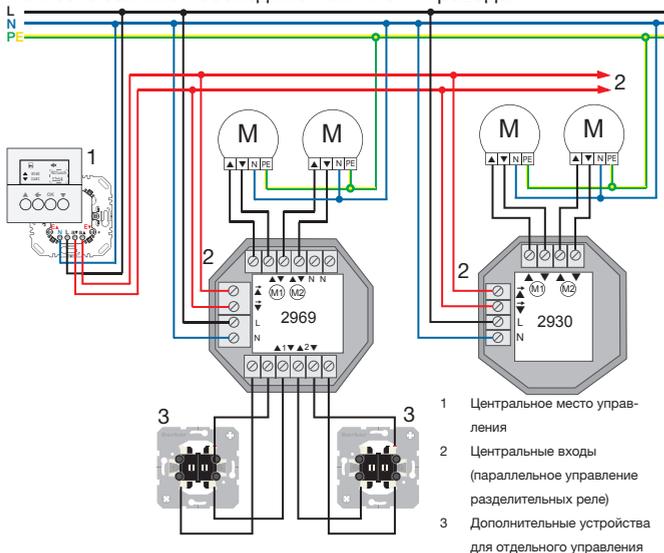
Схема подключения разделительного реле для наружного и скрытого монтажа
